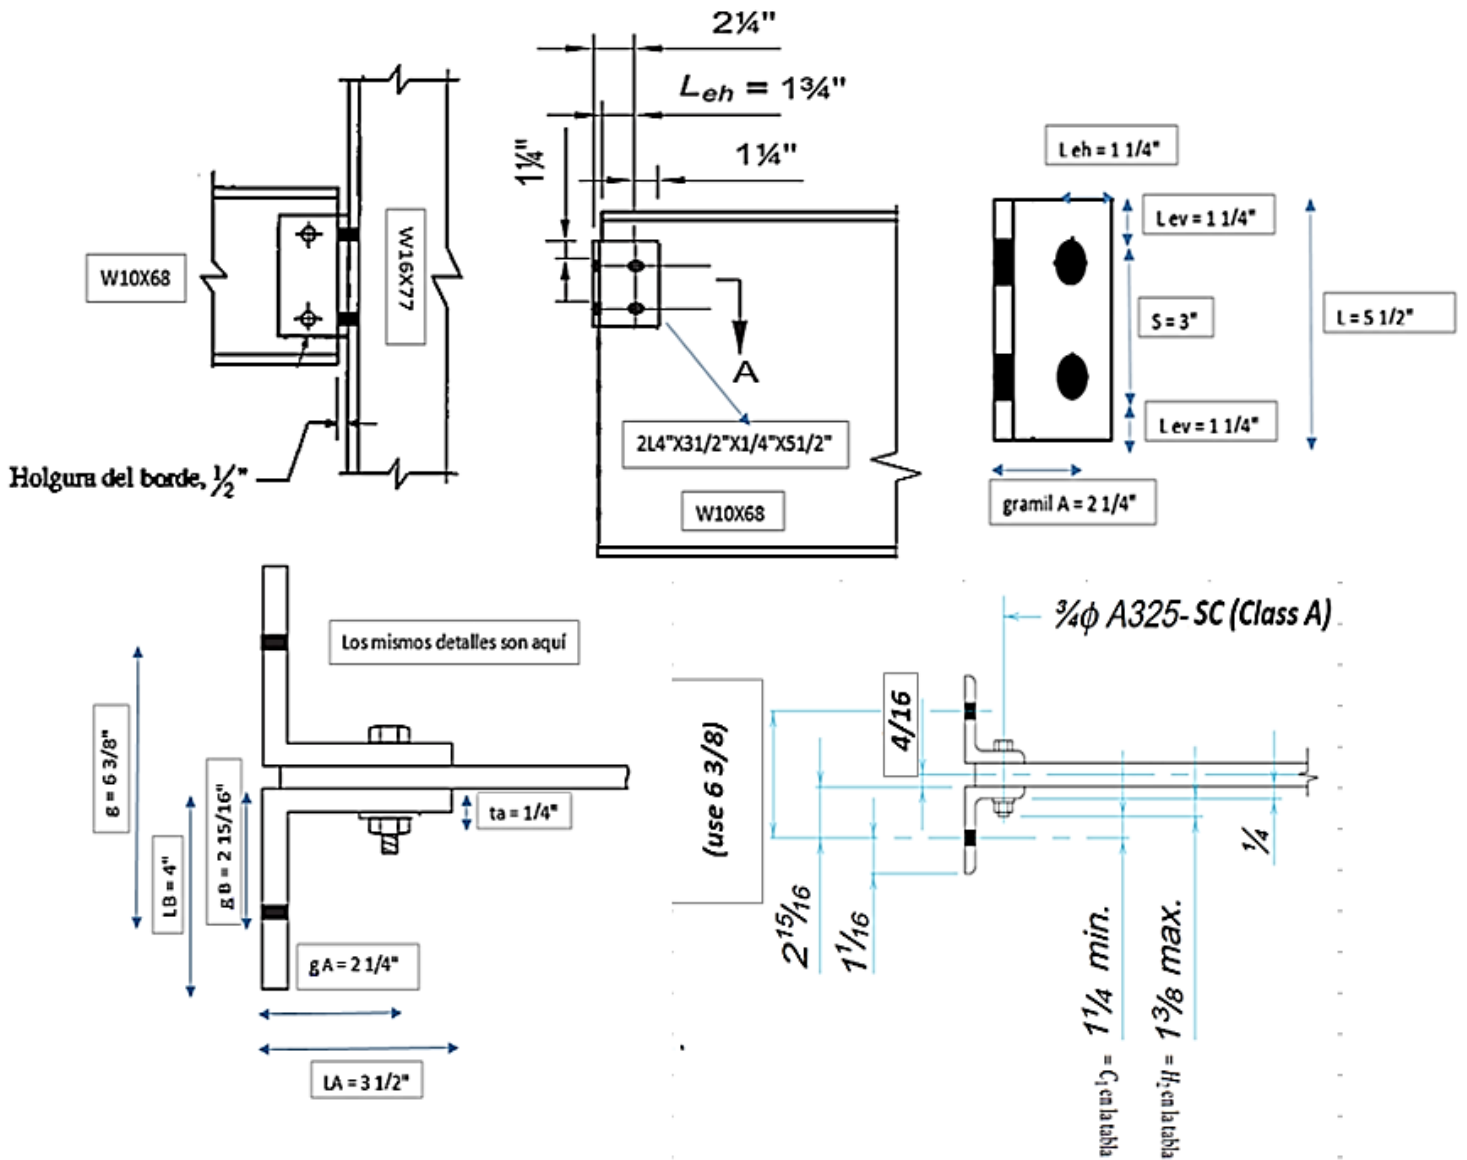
Detalle de conexión simple viga – columna doble ángulo totalmente emperrada
